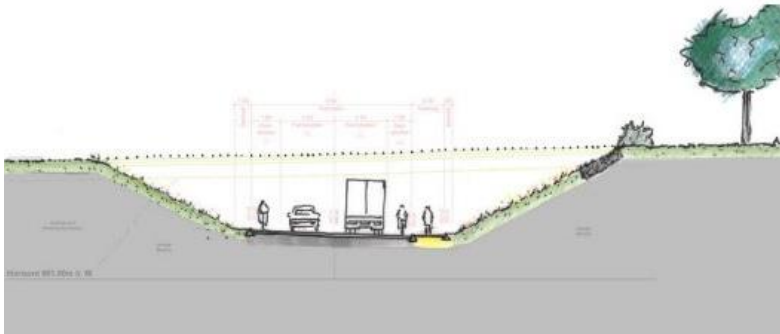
Das Projekt für den Ausbau der Hauptstrasse Gunzwil/Schuelgass: nicht eine Radwegenanlage und Belagsanierung, wie sie bezeichnet ist, sondern eine breite, rein verkehrsorientierte Schneise durch das Dorf!
